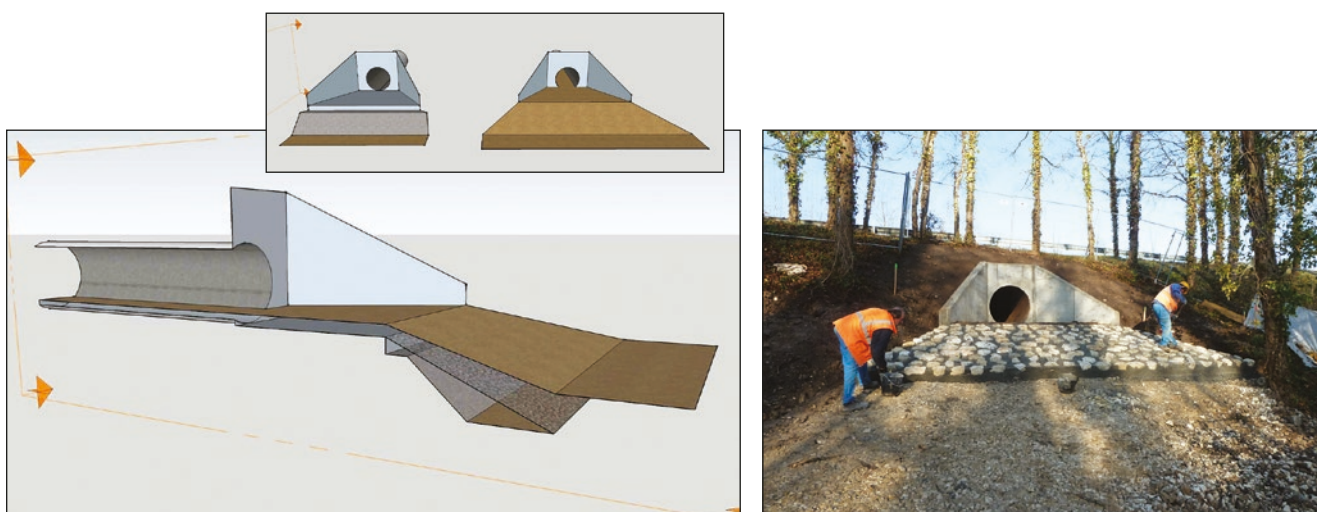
Schéma de principe d'une rampe (gauche) et réalisation d'une rampe maçonnée avant recouvrement de terre.
